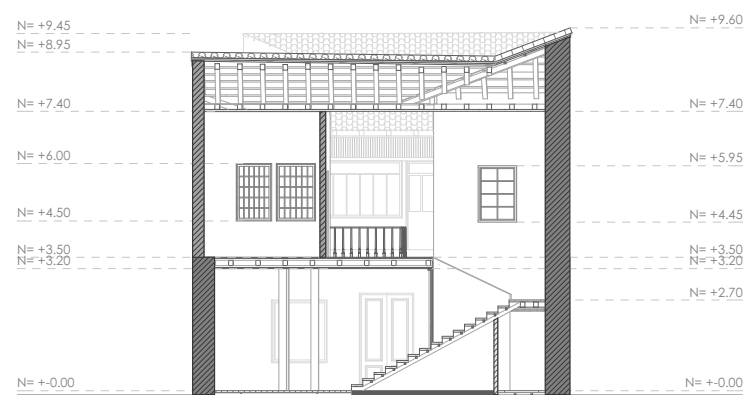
Sección transversal B -B | Caso de estudio 2, Vivienda Berrezueta.
